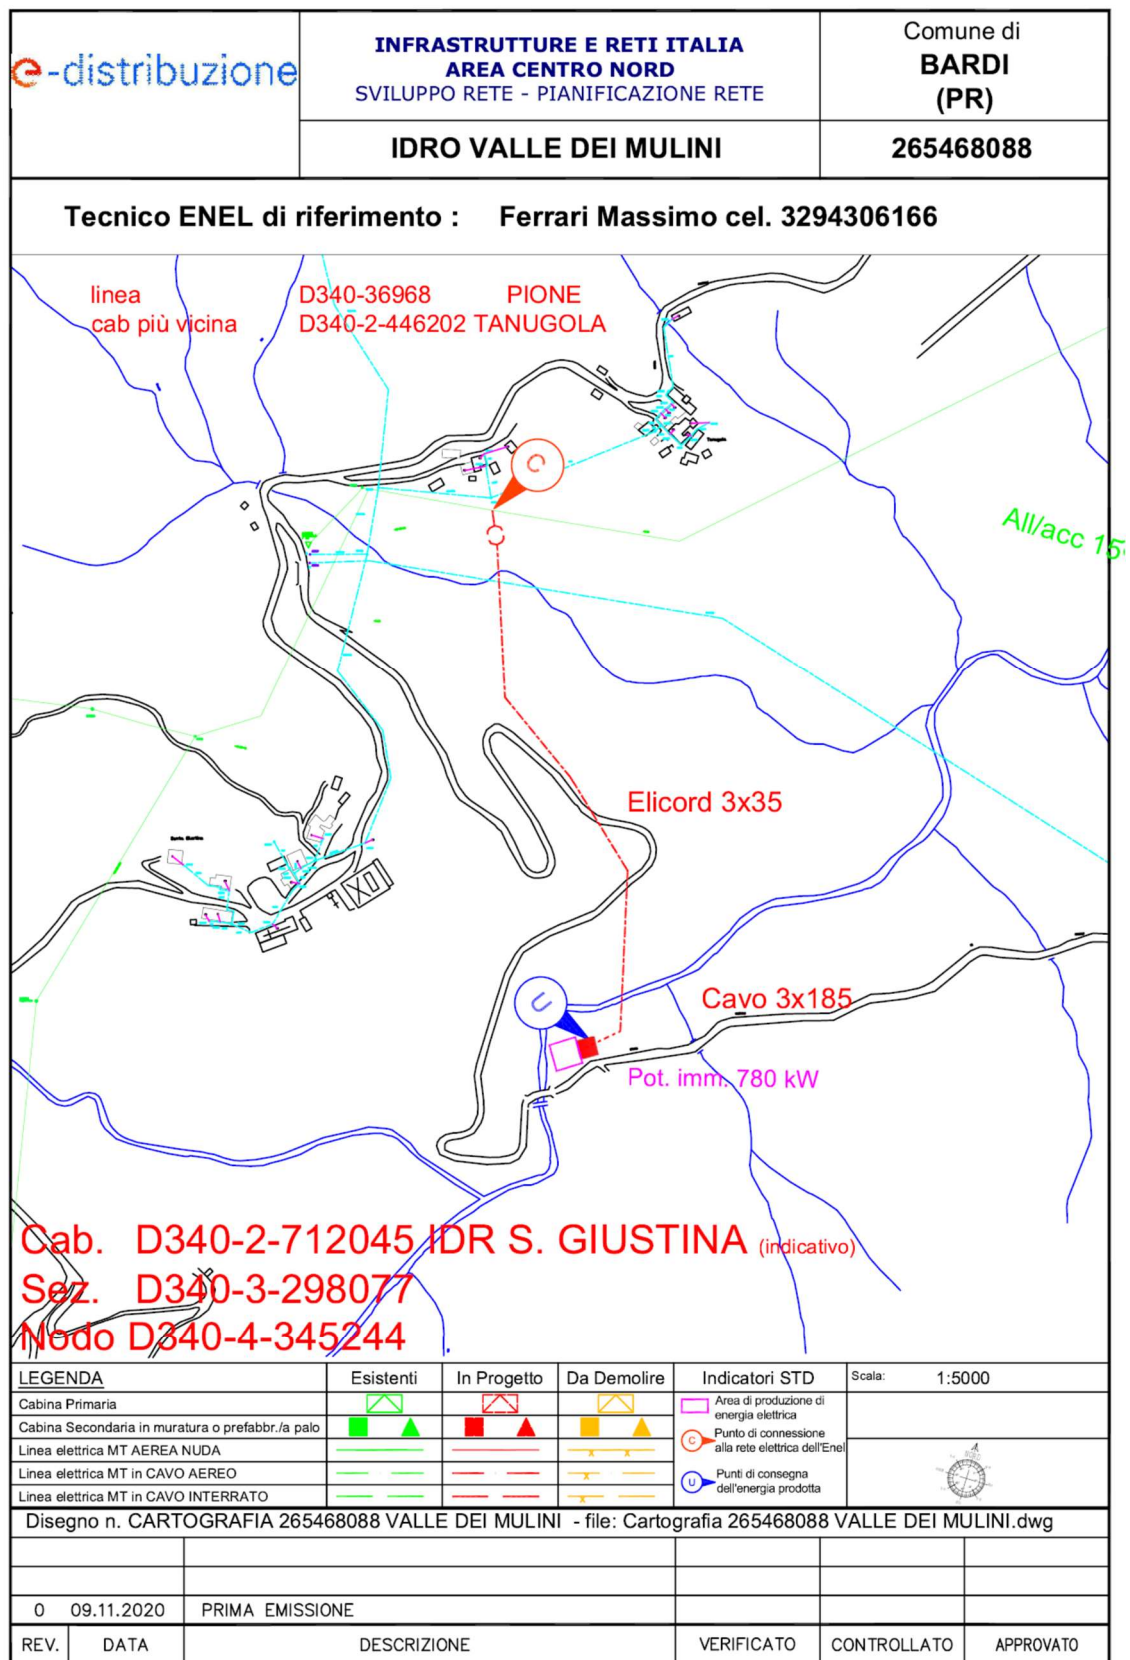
Estratto planimetrico progetto di massima preventivo di connessione.
